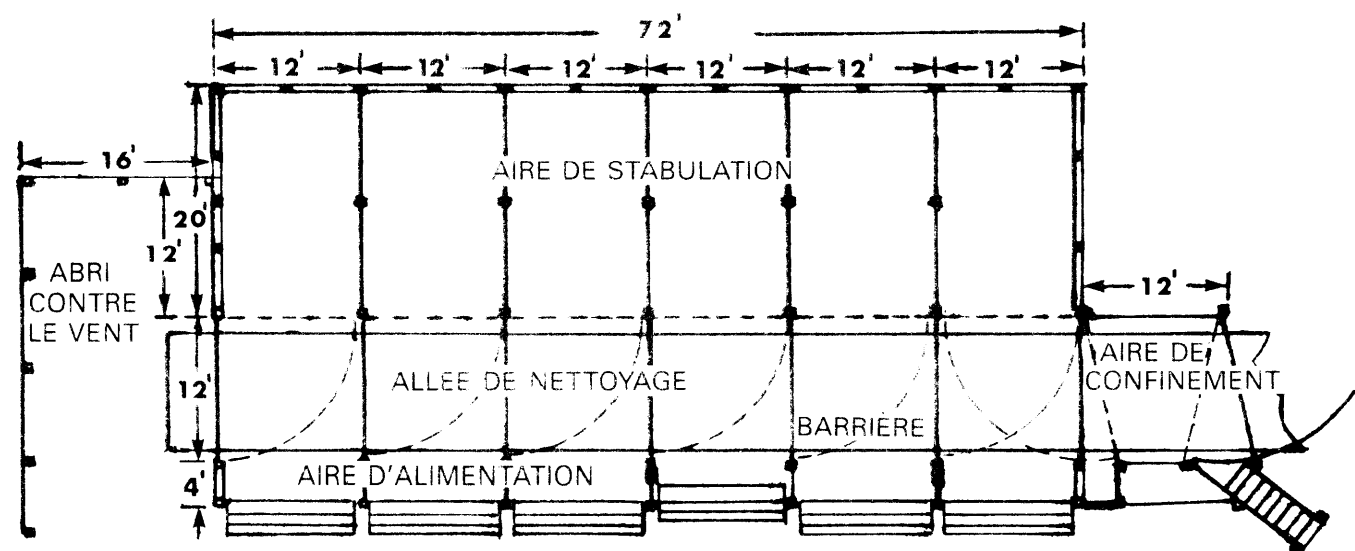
PLAN DE L'ÉTABLE À FAÇADE OUVERTE
